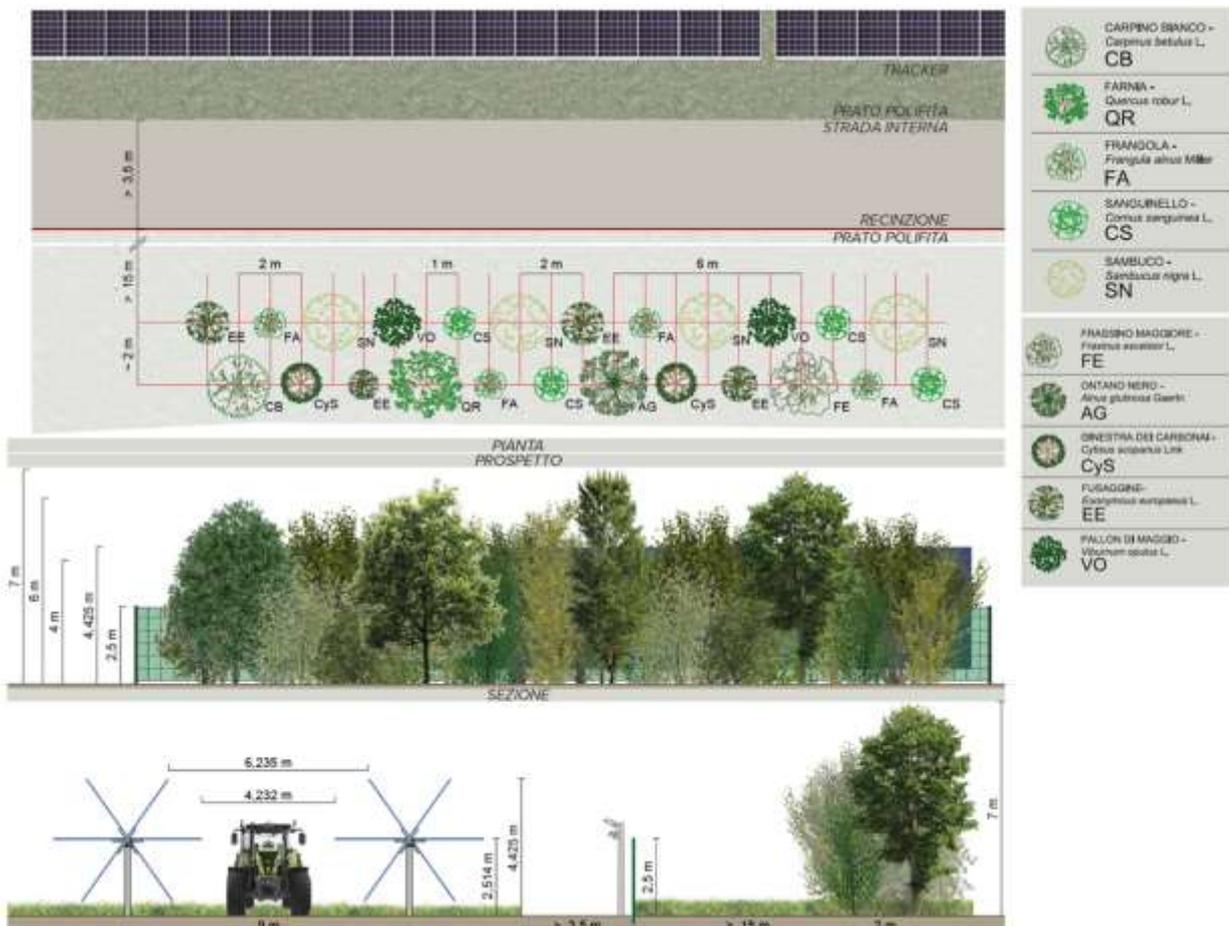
Il sesto d'impianto delle fasce di mitigazione a doppio filare di Tipo 3
